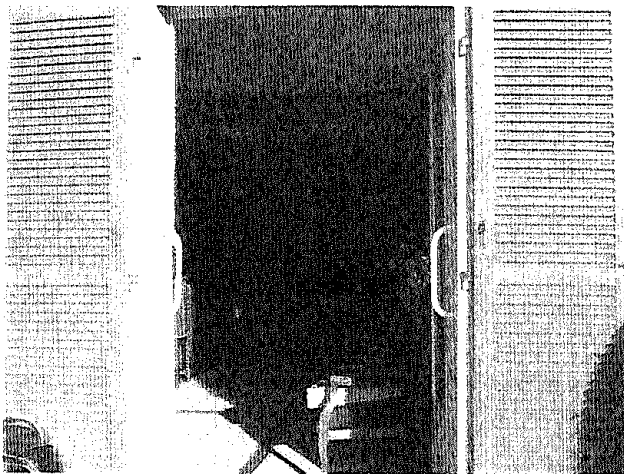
Barres d'appui verticales à l'entrée du salon, facilitant l'accès à la terrasse
